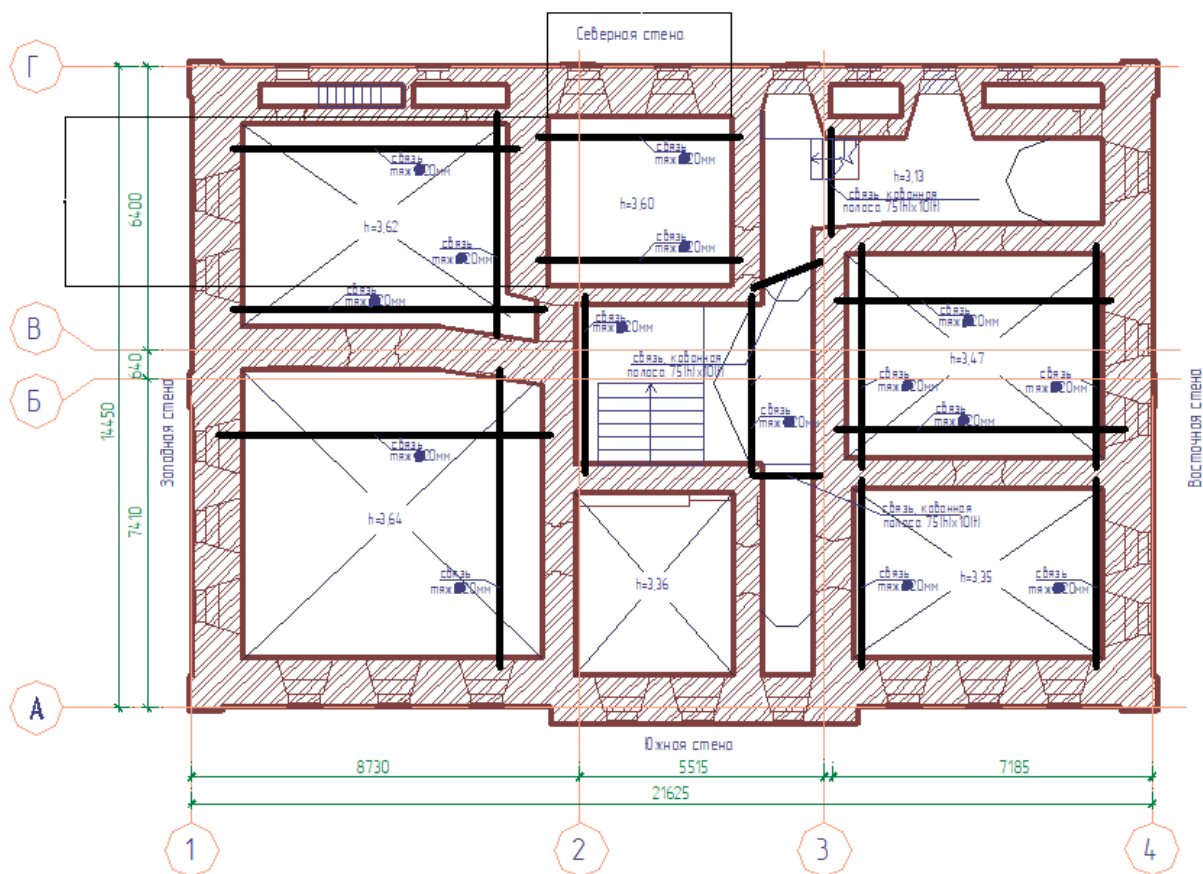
Схема расположения воздушных связей сводов 2 этажа
